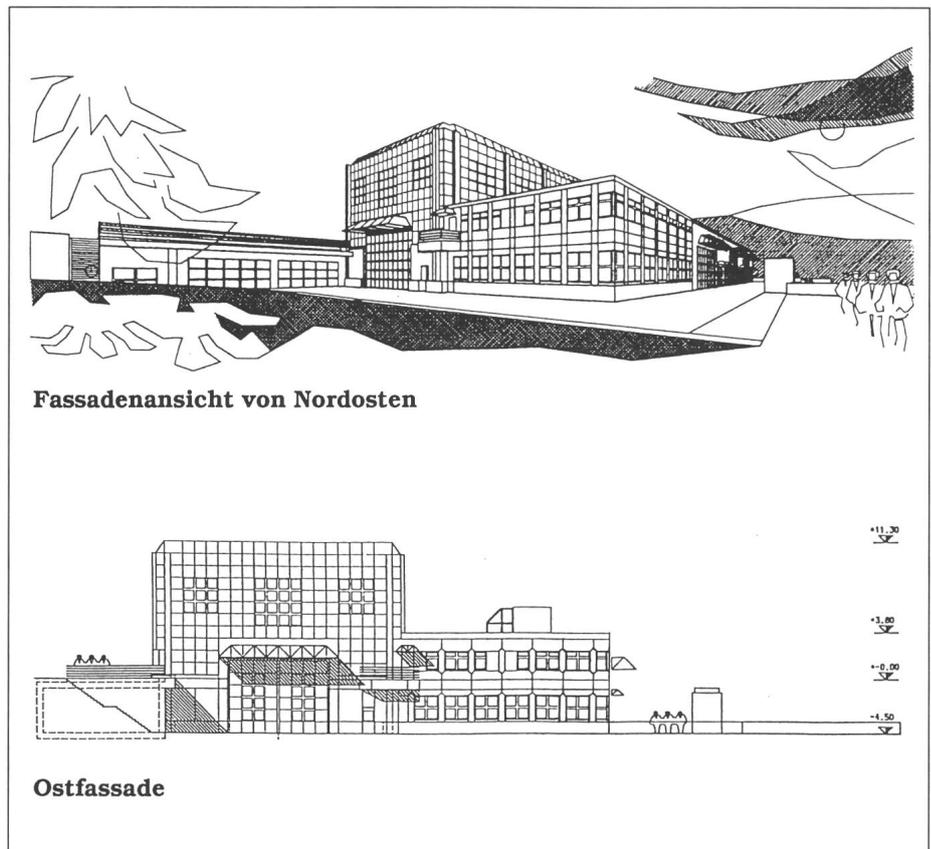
Der geplante Neubau des hydraulischen Kraftwerkes Beznau – Fassadenansichten
